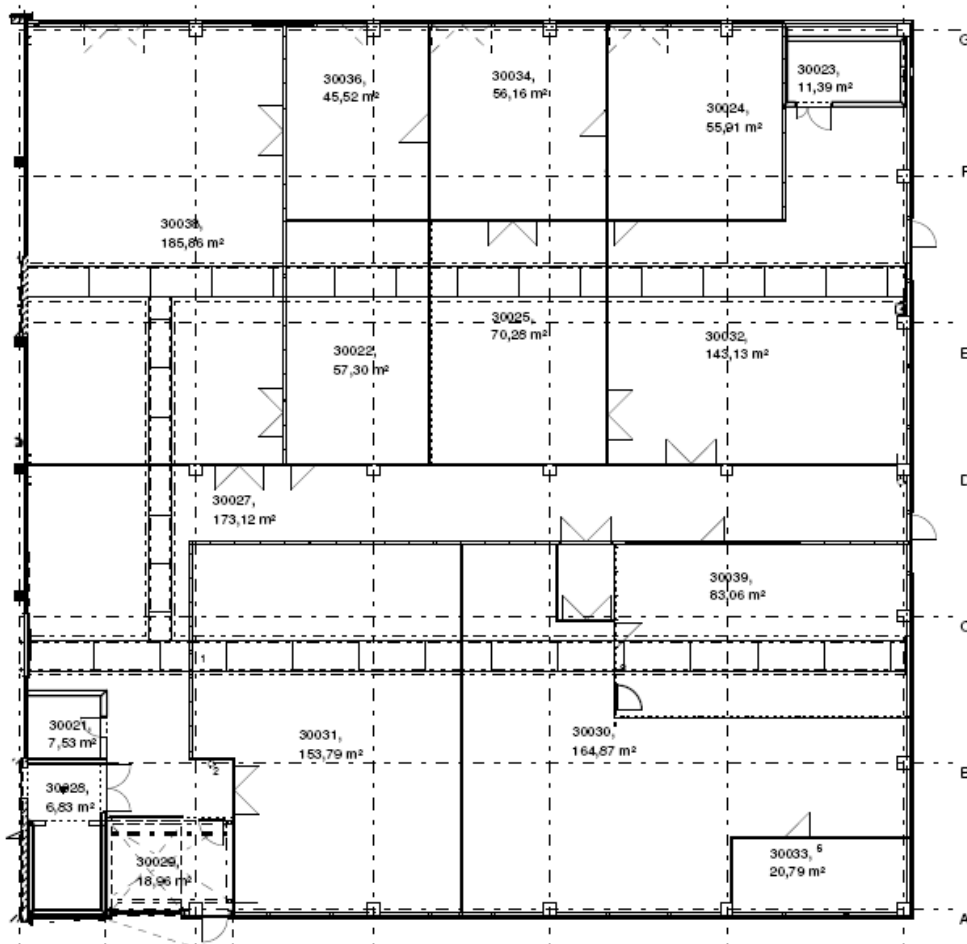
Grundriss B_30,, Bauabschnitt 2, Erdgeschoß
